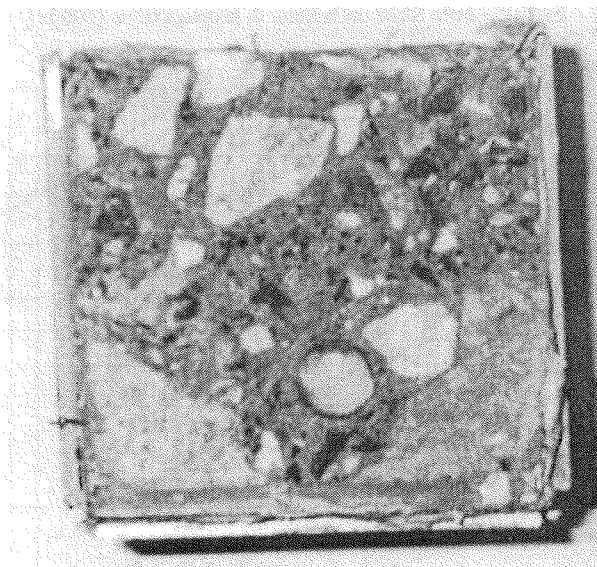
Dettaglio della superficie di rottura - campione P5
